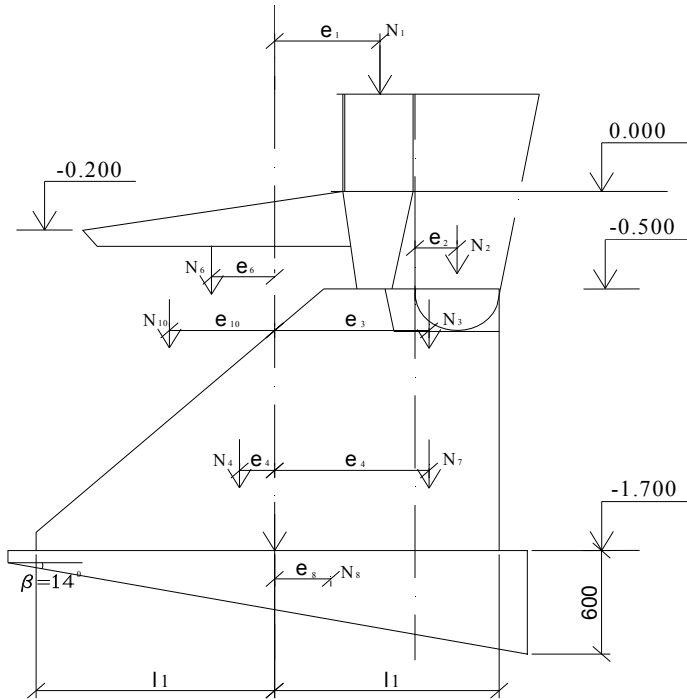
Схема к расчету отдельного фундамента под трехшарнирную раму
